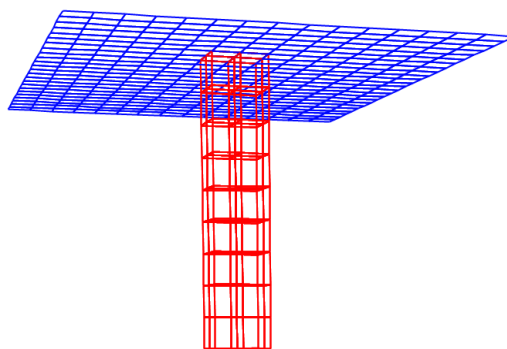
Ligação Laje-Pilar do tipo “OS”, com o pilar modelado em elementos sólidos 3D e a laje em elementos de casca.
